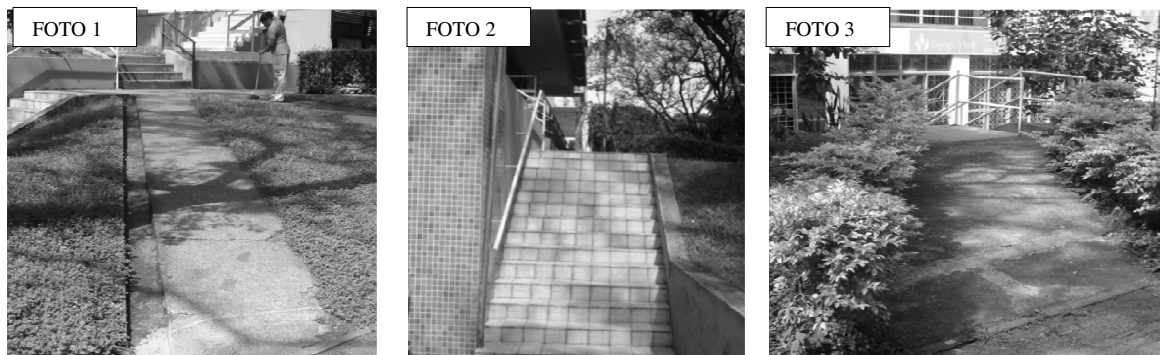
Foto 1, Acesso O; Foto 2, Escada 106NAE4; Foto 3, Acesso Q
